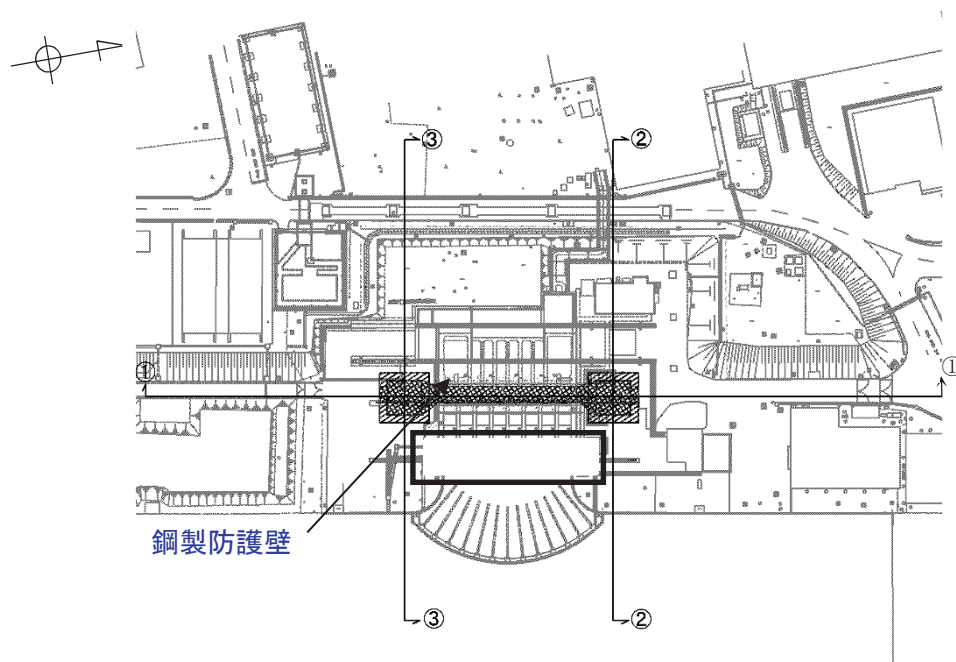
(1) 防潮堤（鋼製防護壁）の平面図
